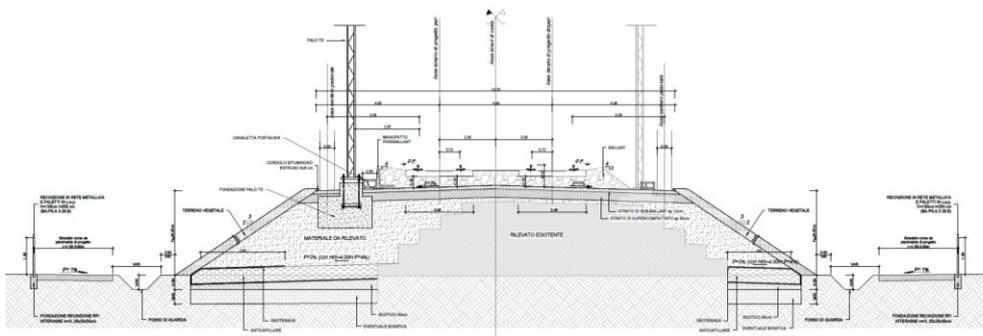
Sezione tipo in rilevato con raddoppio a 4.00m e innalzamento del piano del ferro
